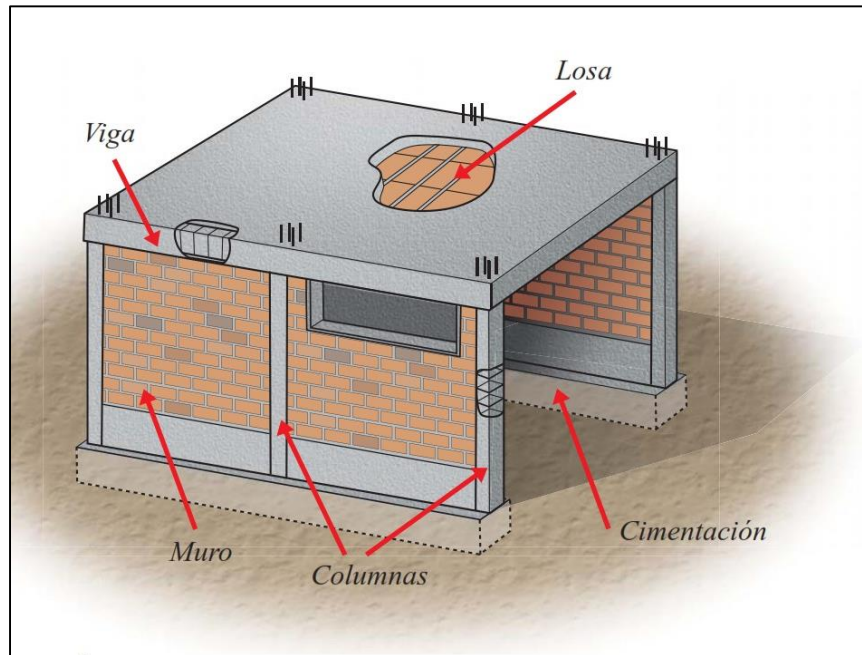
Elementos Estructurales (Uribe, 2017)
